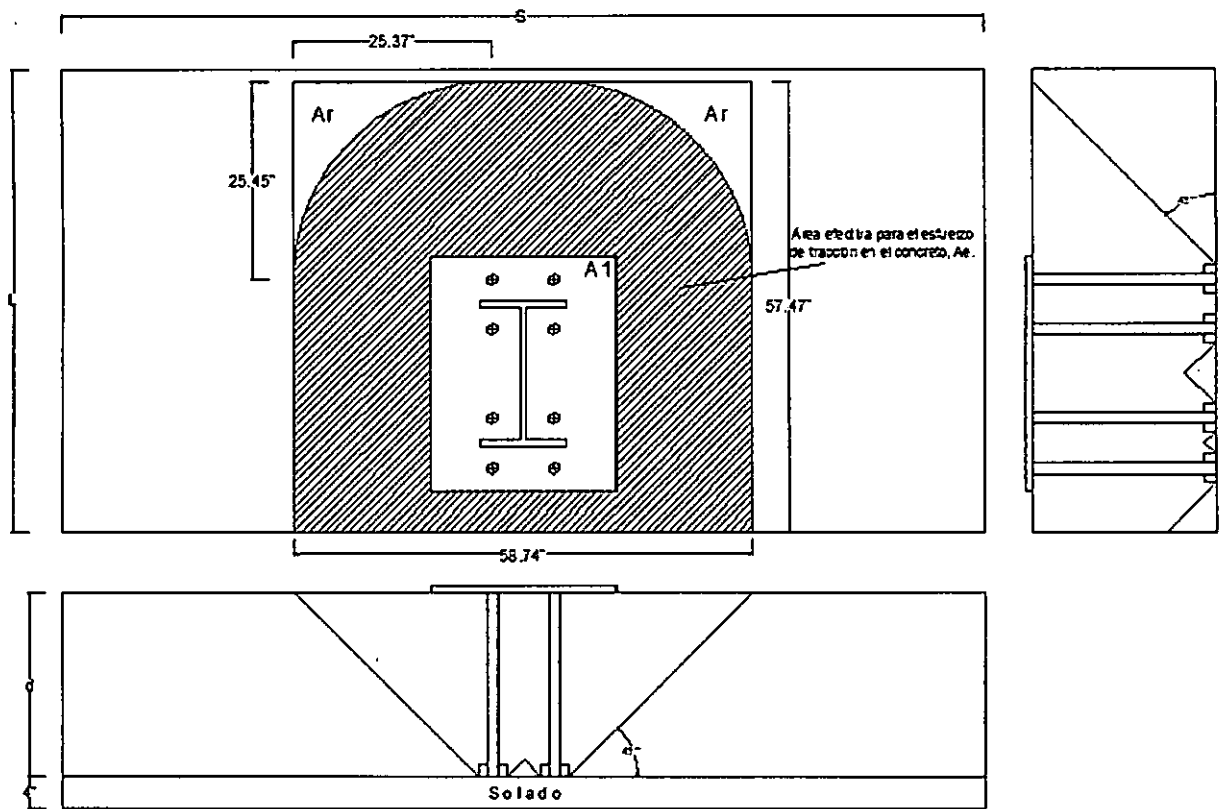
Vista en Planta para el cálculo del área efectiva
